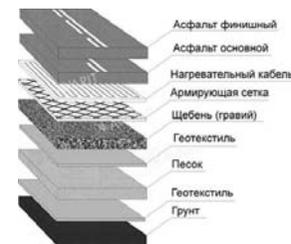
Установка нагревательного кабеля при асфальтном покрытии
